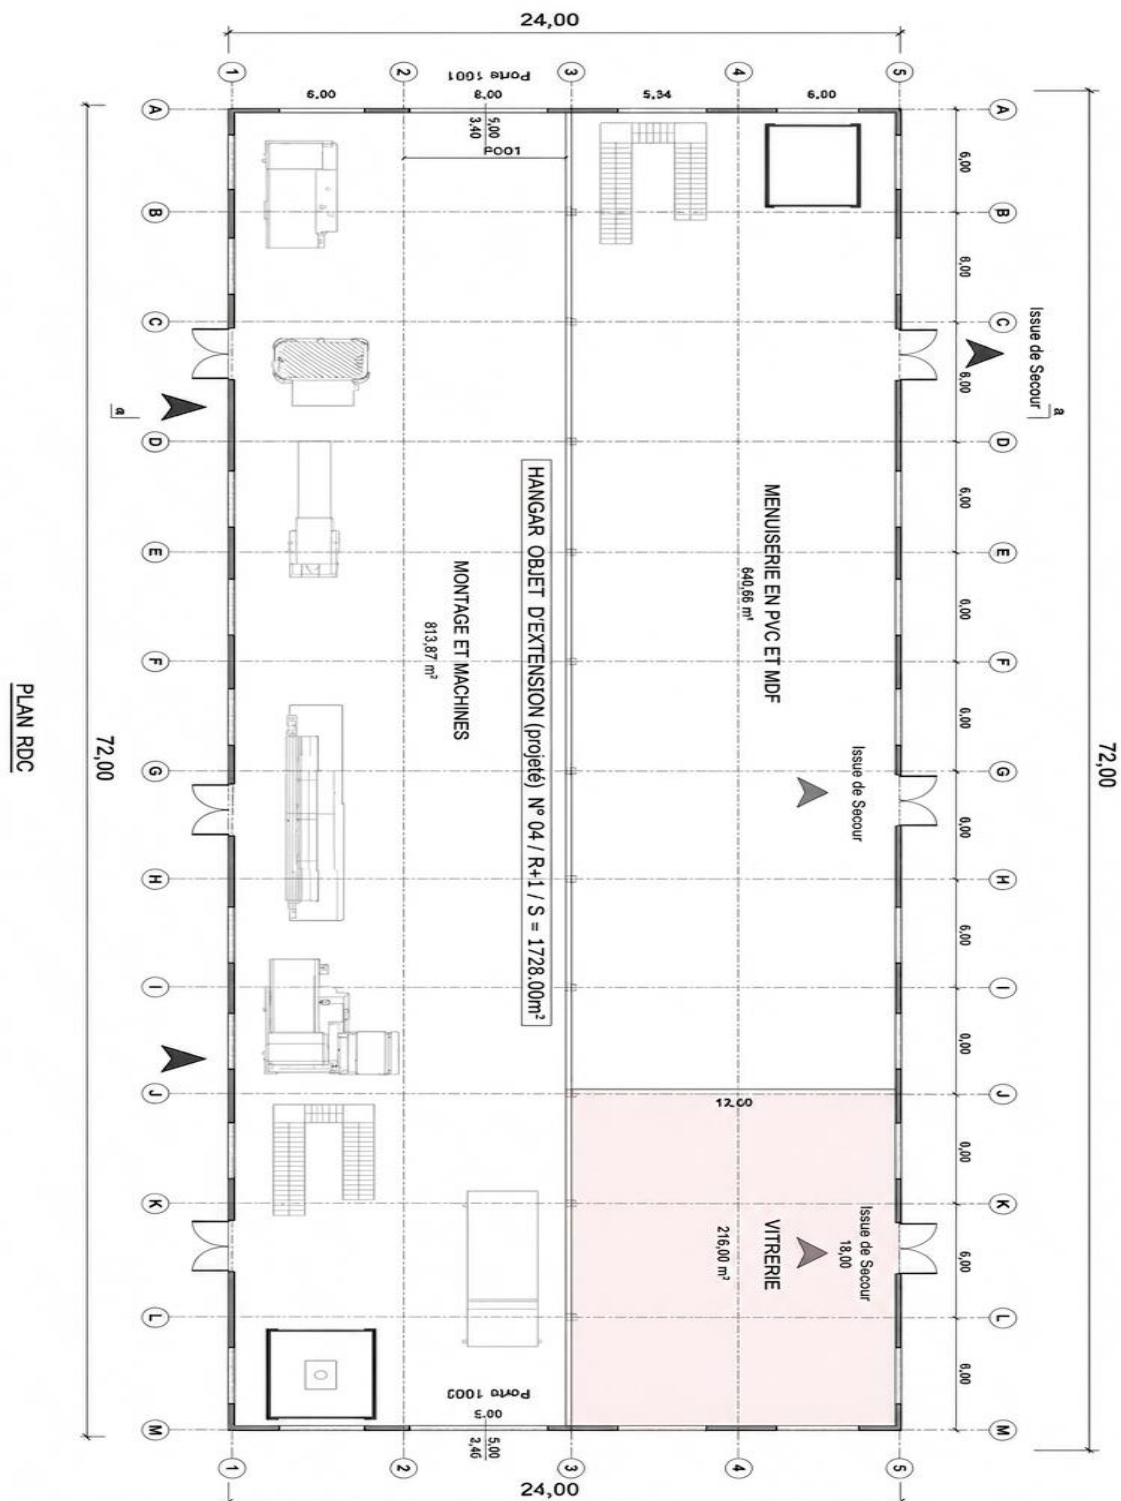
Plan du rez-de-chaussée du hangar industriel
